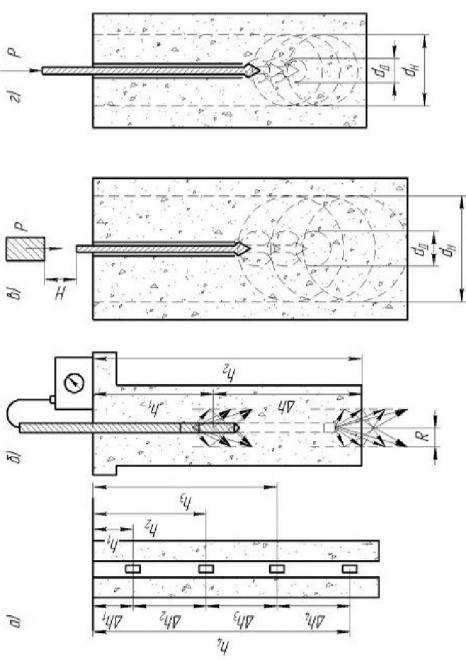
Схеми методів дослідження ґрунтів: а – прохід свердловини з відбором зразків; б – розділяючий каротаж; в – динамічне зондування; г – статичне зондування
